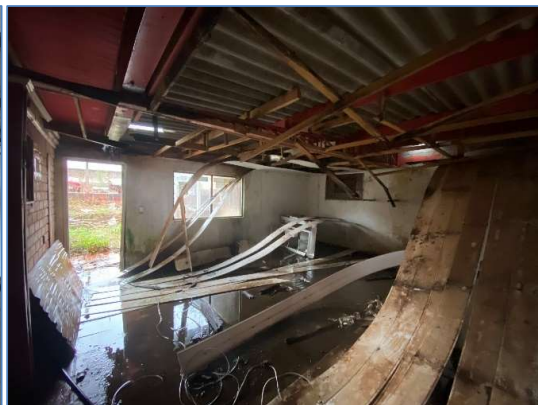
vista interna da área administrativa. Danos nos forros, danos no telhado, infiltrações generalizadas, deterioração do madeiramento, mau estado de conservação.
